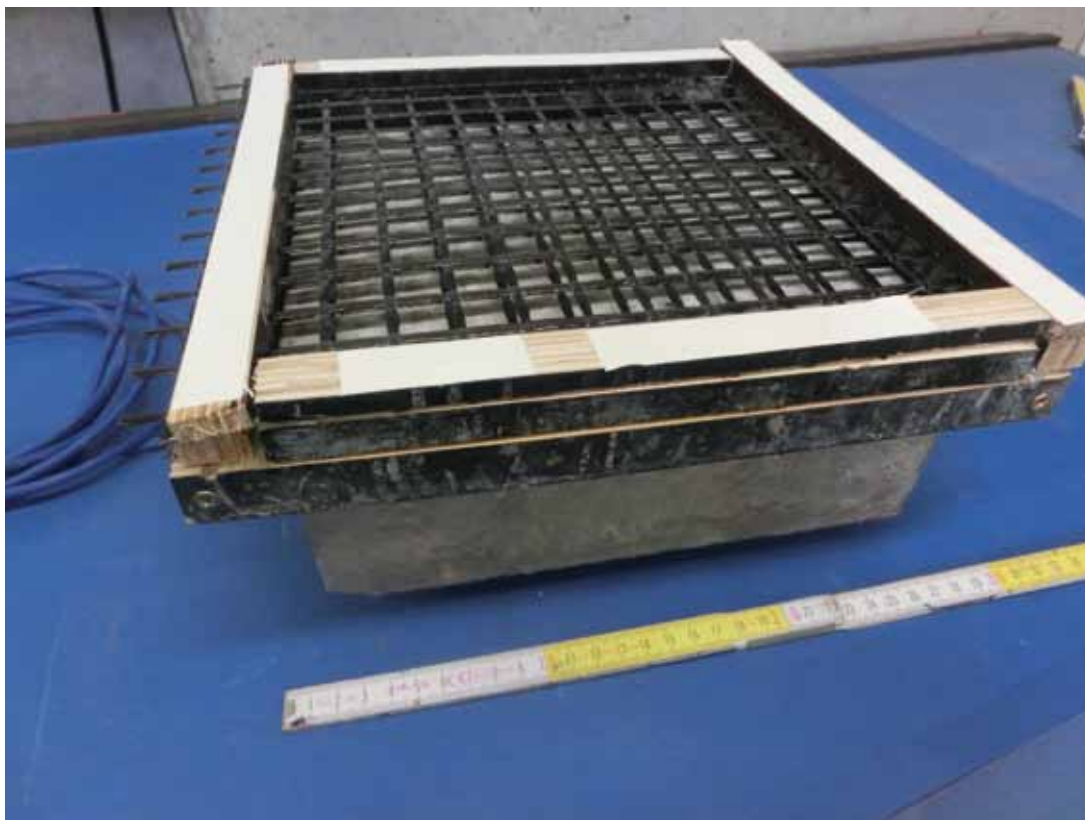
Prüfkörper mit Smart-Deck-Aufbau (oben) und Anschlüssen (unten).
